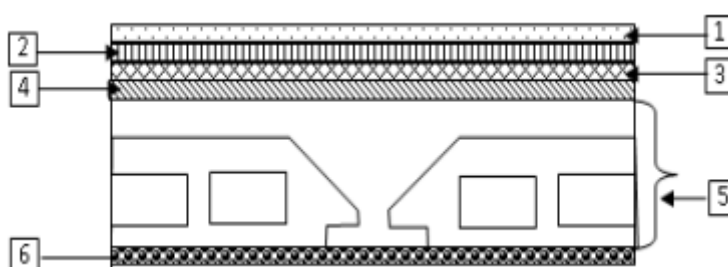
Coupe transversale d'un plancher terrasse inaccessible.
